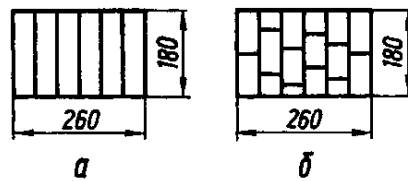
Поперечні перерізи дерев'яних клеєних брусів:
